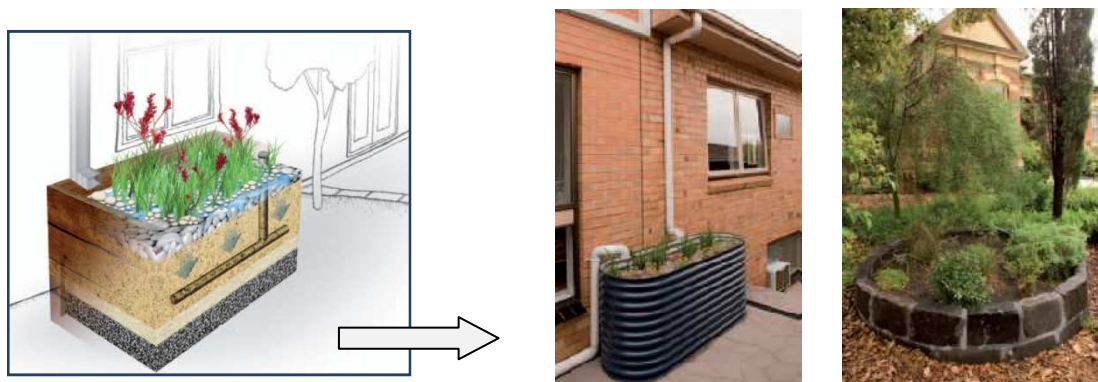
Exemplos de biofiltros com estrutura elevada em escala de lote.
